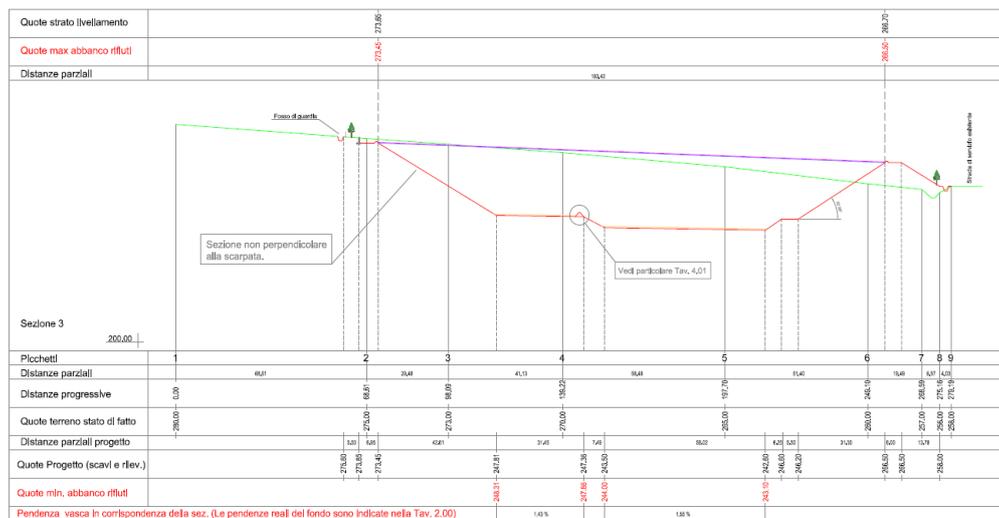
stralcio dalla TAV. 2.02 “Sezioni discarica lotto A”
